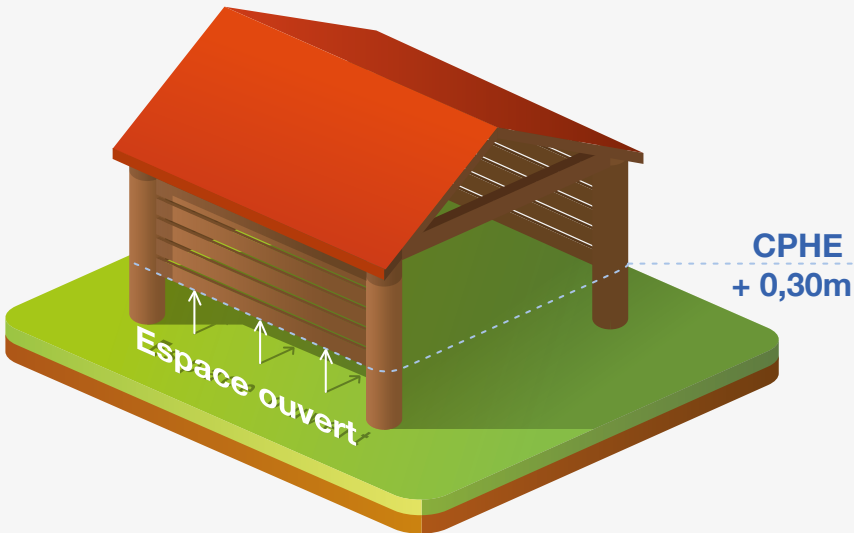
Illustration d'une construction autre qu'un bâtiment ne comportant pas de paroi sous la CPHE.
